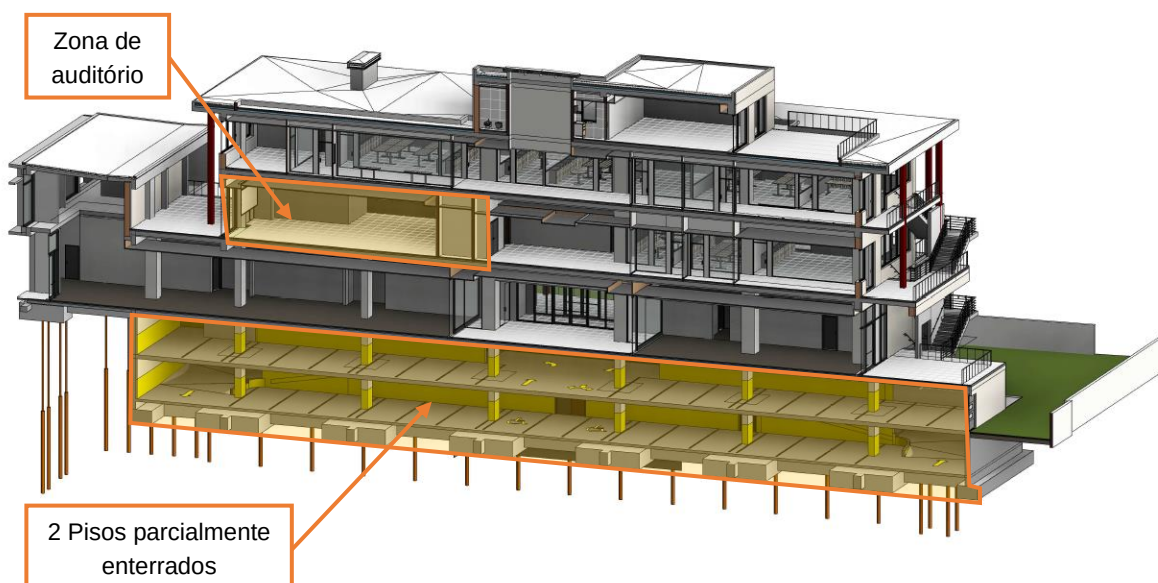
Corte longitudinal do modelo BIM elaborado (Estruturas + Arquitetura)
